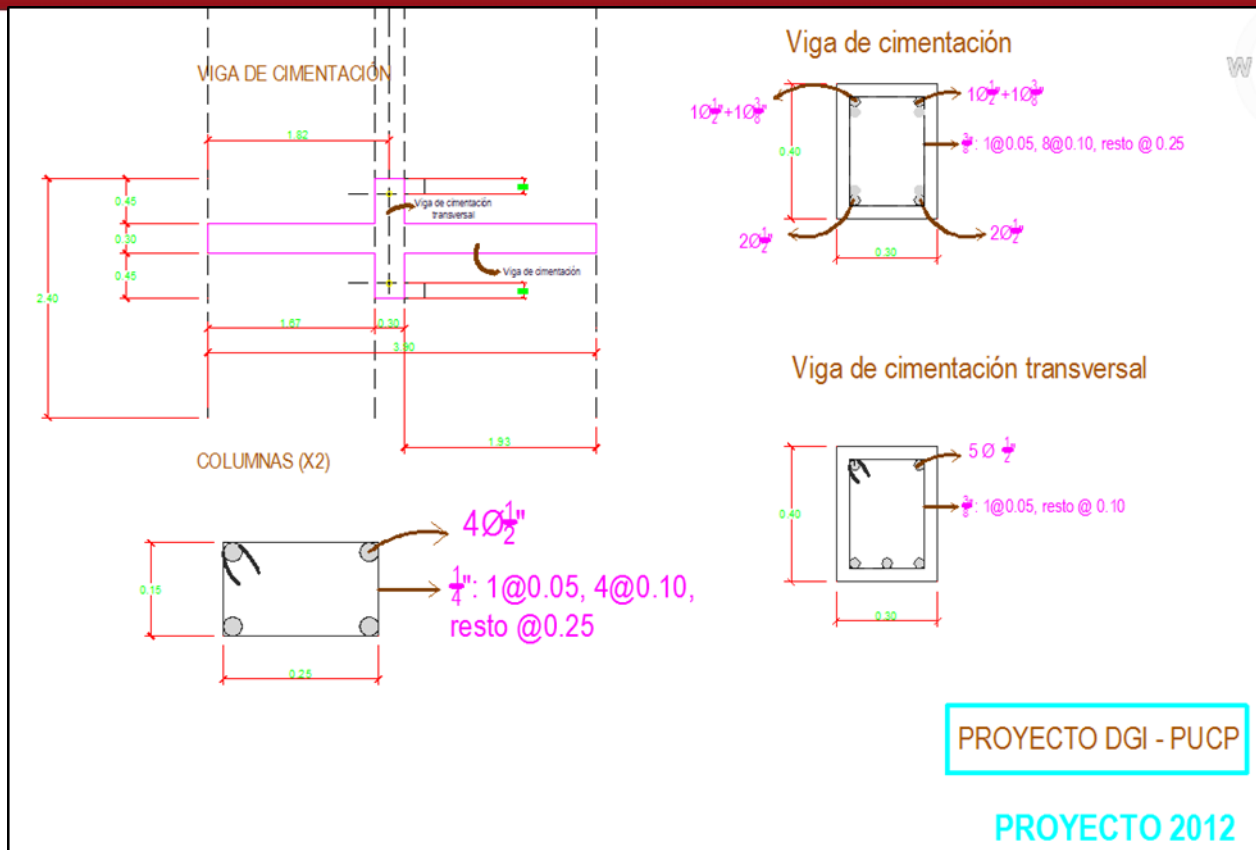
Refuerzos de Acero en Muro de Albañilería M66%(m)
